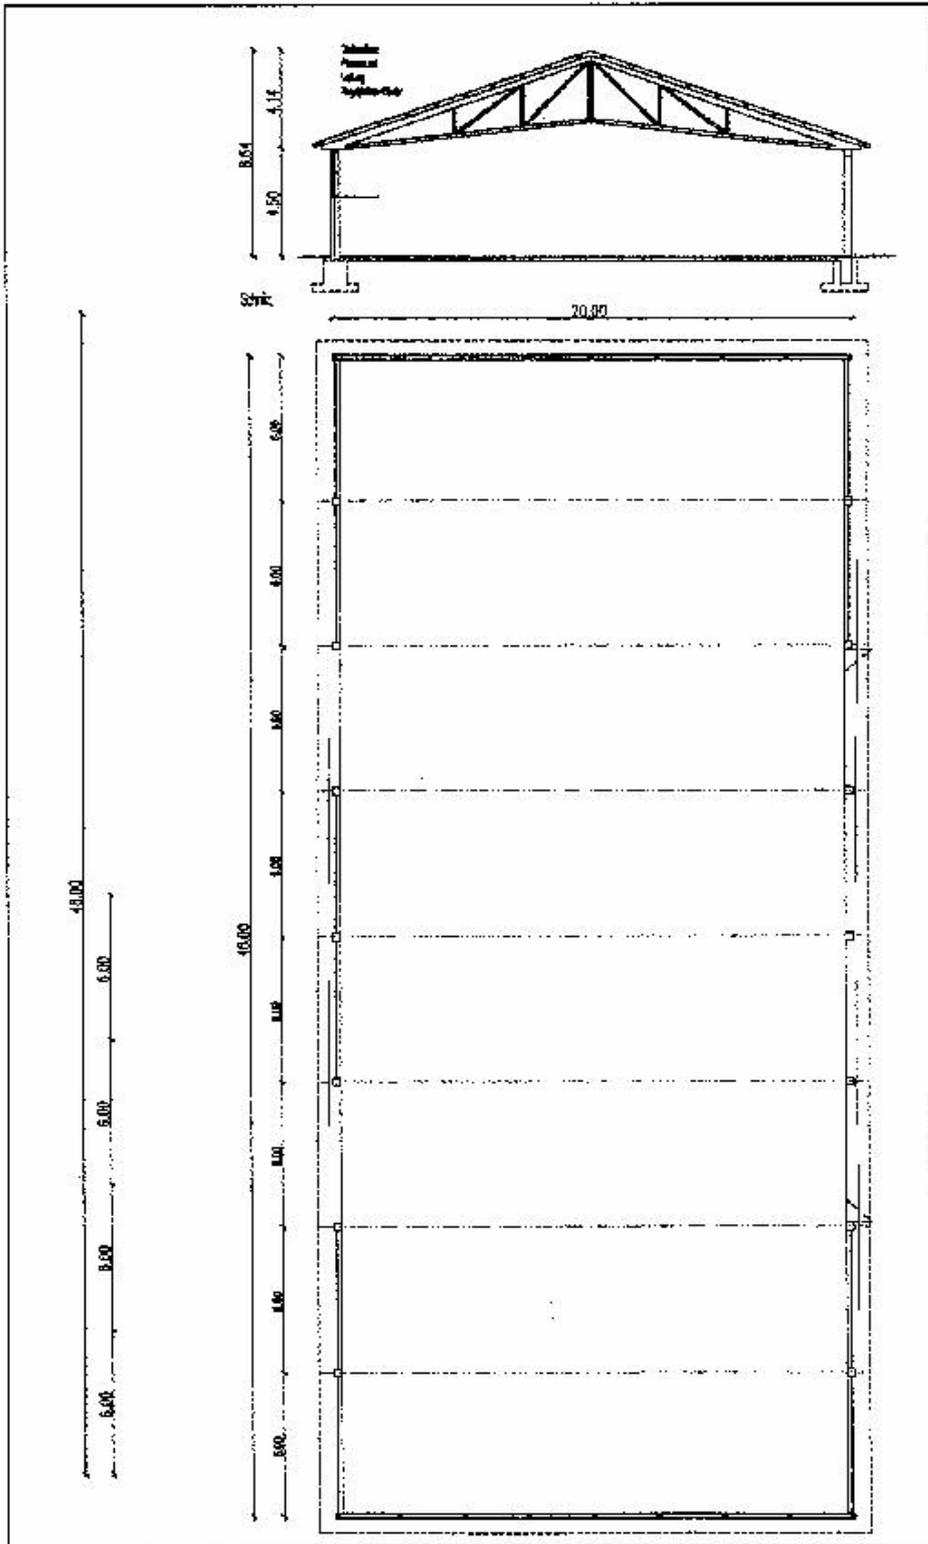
Plan einer Halle (Werkbild Landbau Schwarz GmbH)
